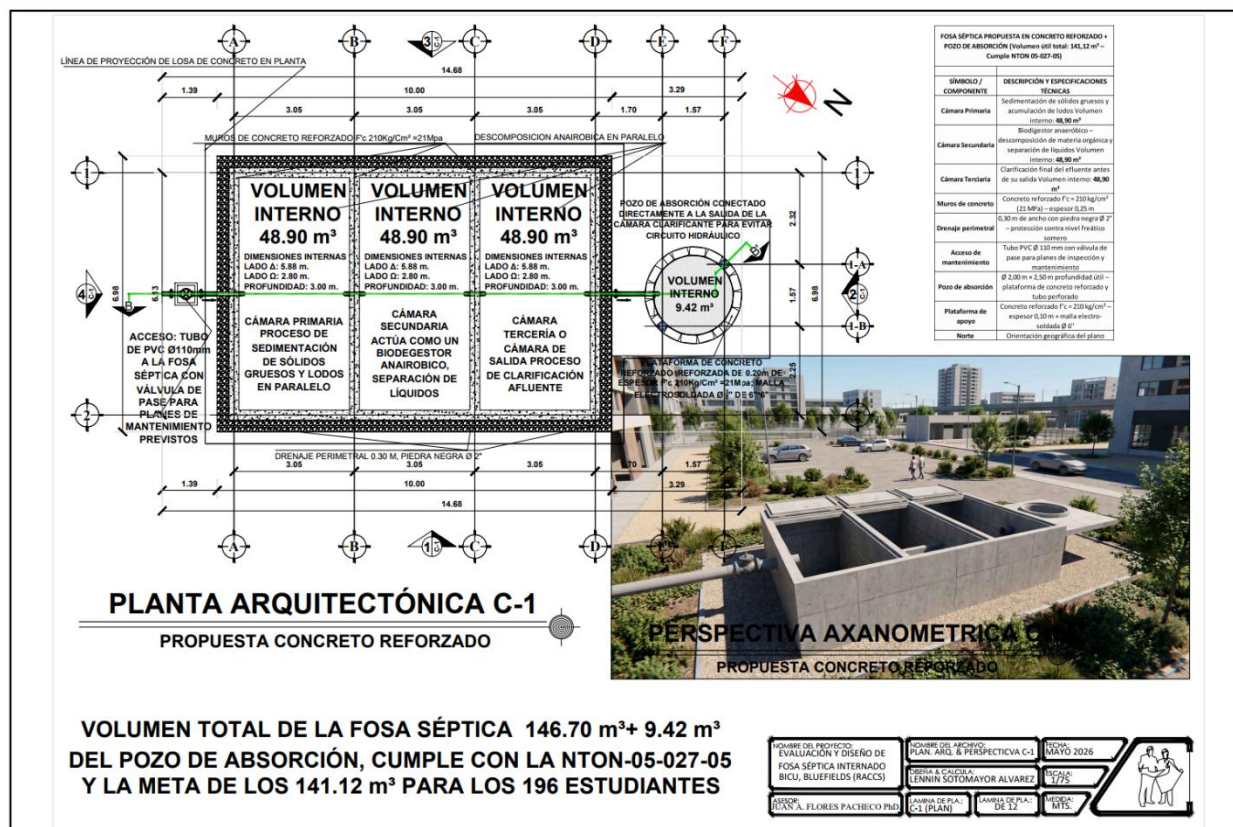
Planta arquitectónica y perspectiva axonométrica de la alternativa de fosa séptica en concreto reforzado para el internado de BICU, Bluefields.
